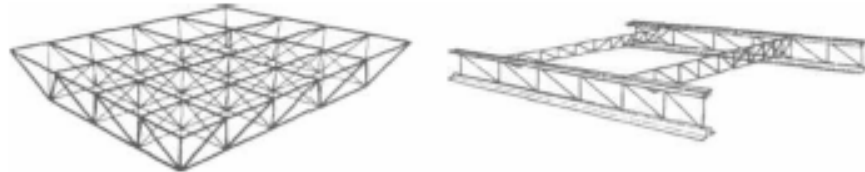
11 Sistema de marco tridimensional y Sistema de armadura con conexión horizontal
